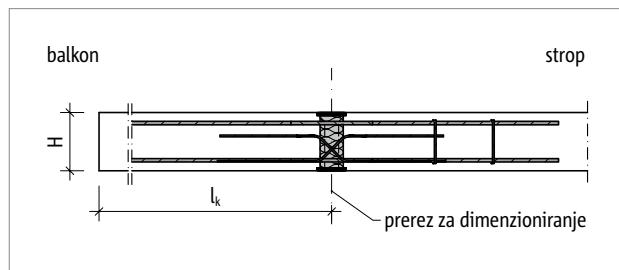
Schöck Isokorb® T tip DP: statičen sistem
